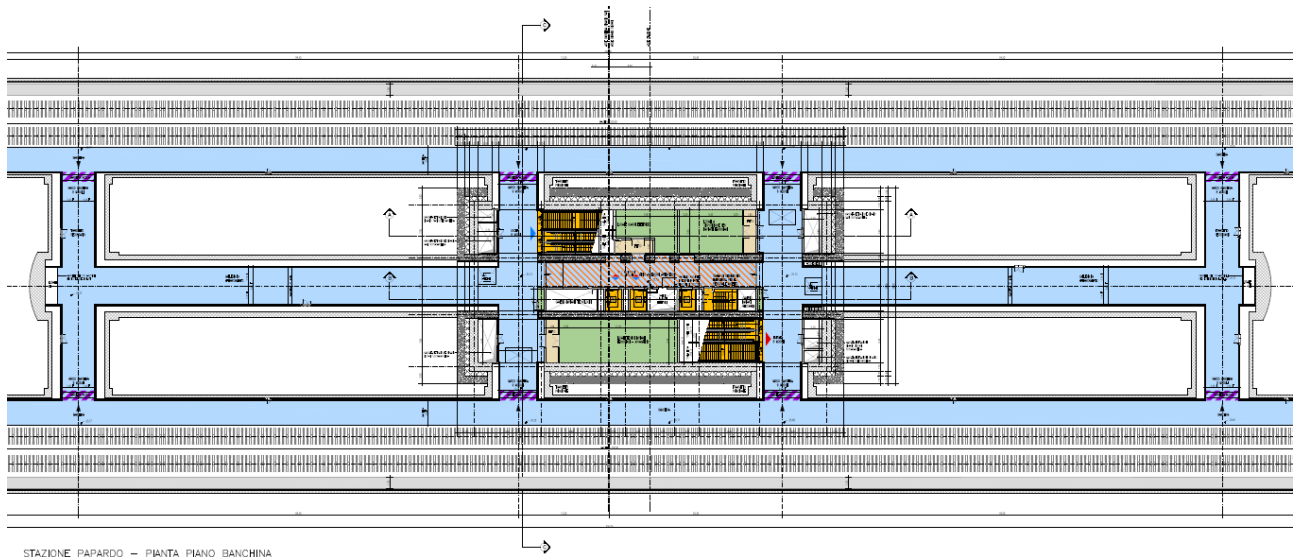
Pianta piano banchina Stazione Papardo (rif. elab. ST0087)
